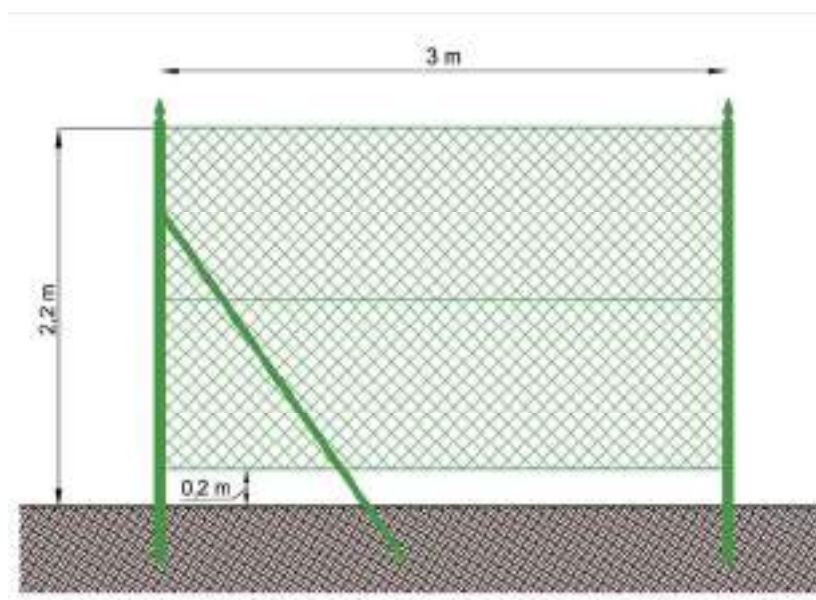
Particolare della recinzione di cui è prevista l'installazione
